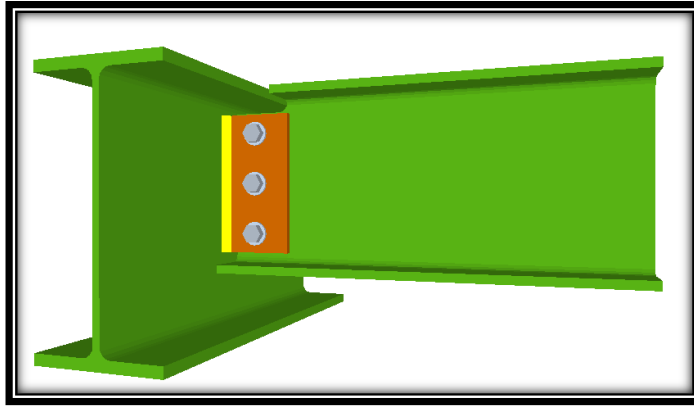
Assemblage boulonné d'une poutre articulée à une autre via une platine latérale ; Source auteurs
